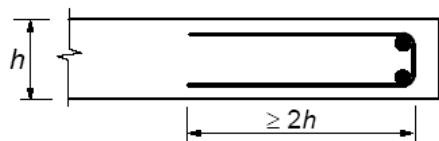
Randbewehrung an freien Rändern von Platten
